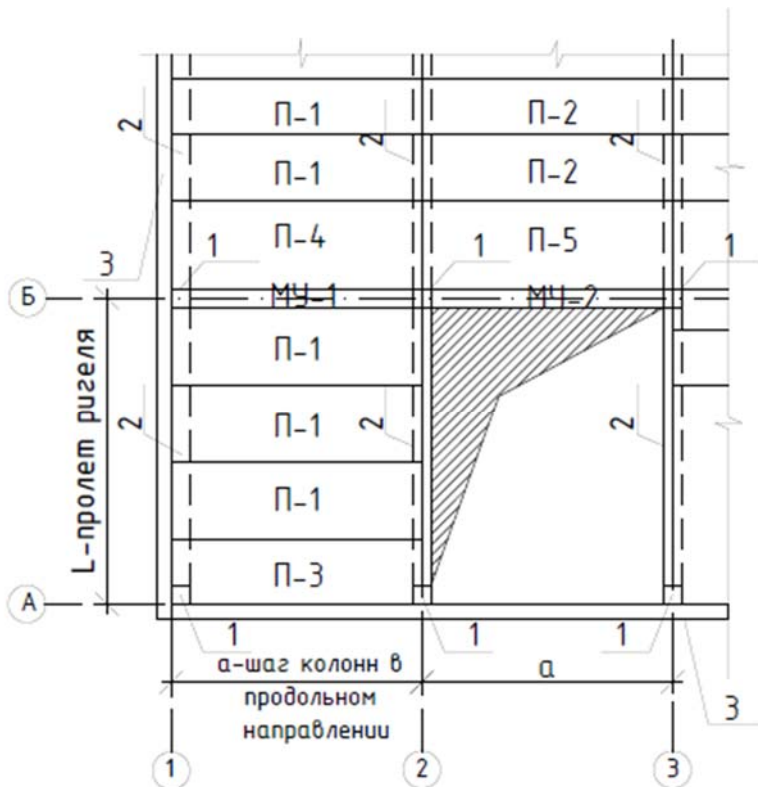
Раскладка сборных плит перекрытия с монолитными участками в створах колонн:
